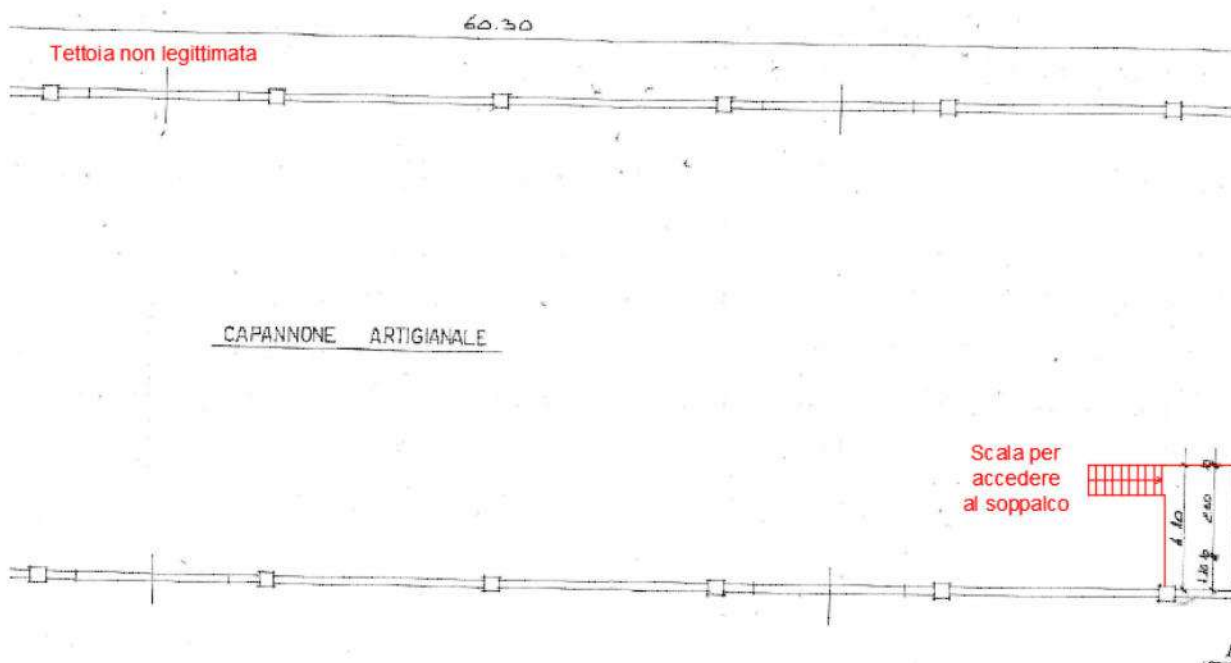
2/3 stralcio Pianta piano terra, si sono rilevate difformità interne (come scala per accedere al soppalco, parapetto non regolamentare poiché scalabile) e tettoia esterna posta ad est, le difformità eccedono del 2% - Fuori Scala
